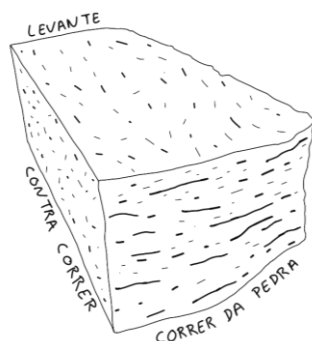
Direções da pedra: o correr da pedra, contra correr e levante
